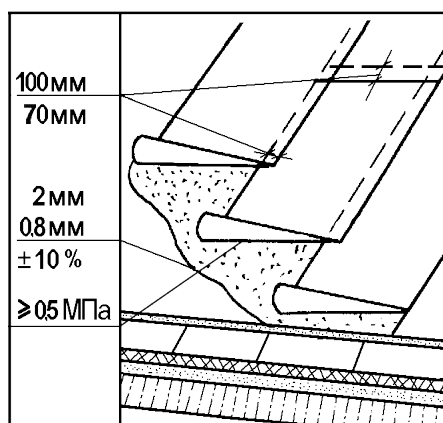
Схема допускаемых отклонений при приемке покрытия кровли
